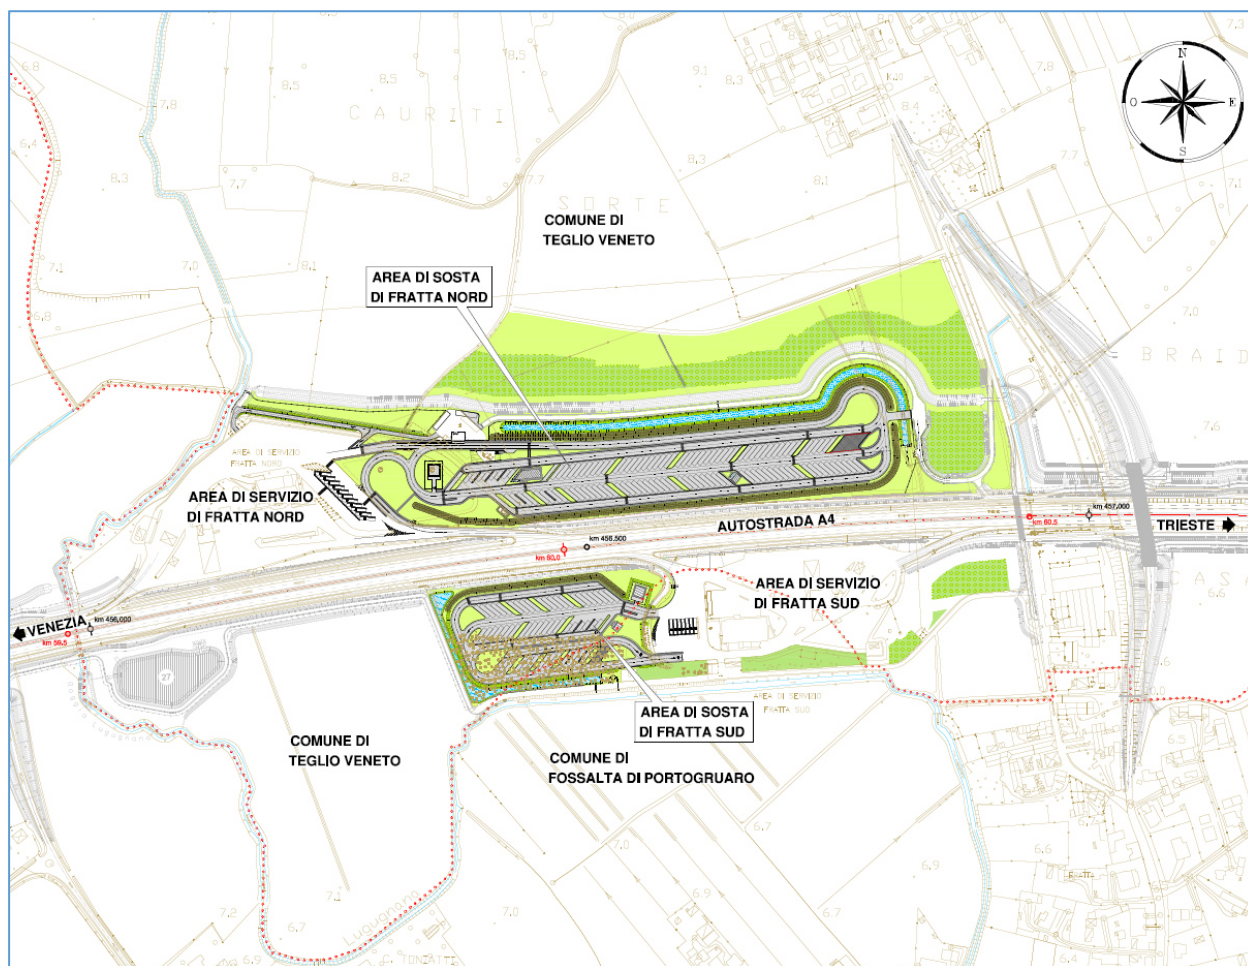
Planimetria di inquadramento (stralcio elab. E.01.00.0.0).
